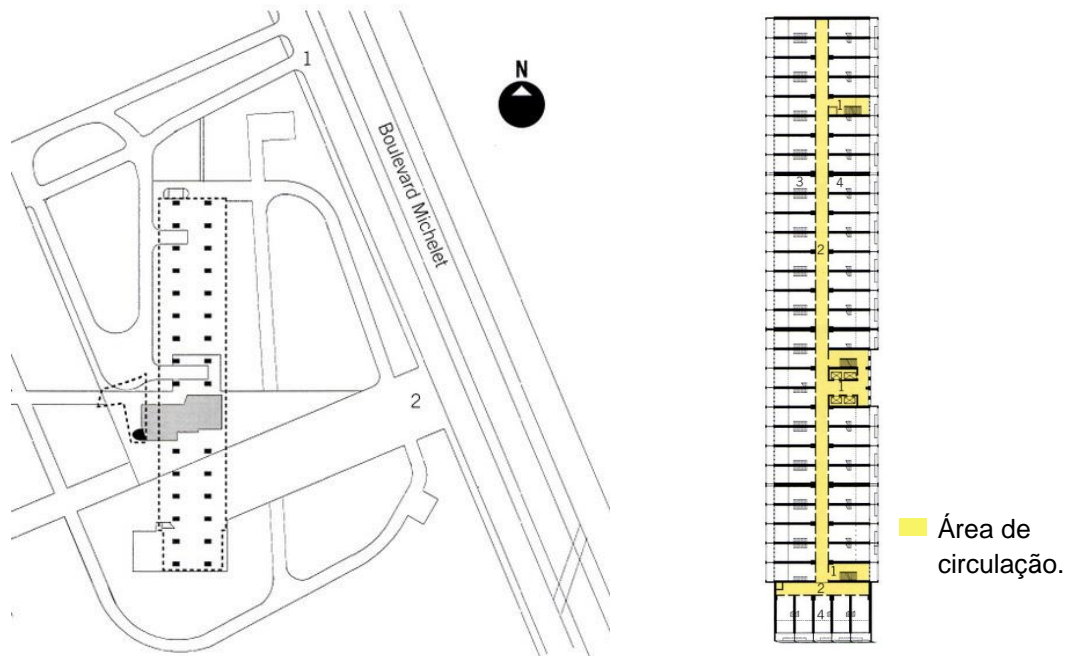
Implantação da Unidade de Habitação de Marselha, França (à esquerda). Planta de um do pavimentos (à direita).
